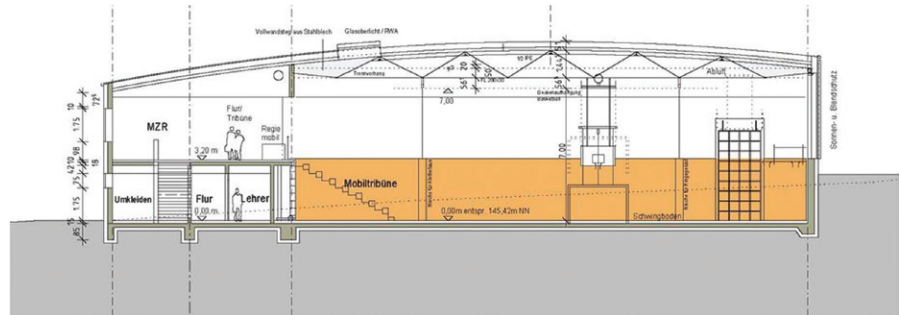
Sección transversal. Cortesía del despacho Möller, Bad Nauheim.
